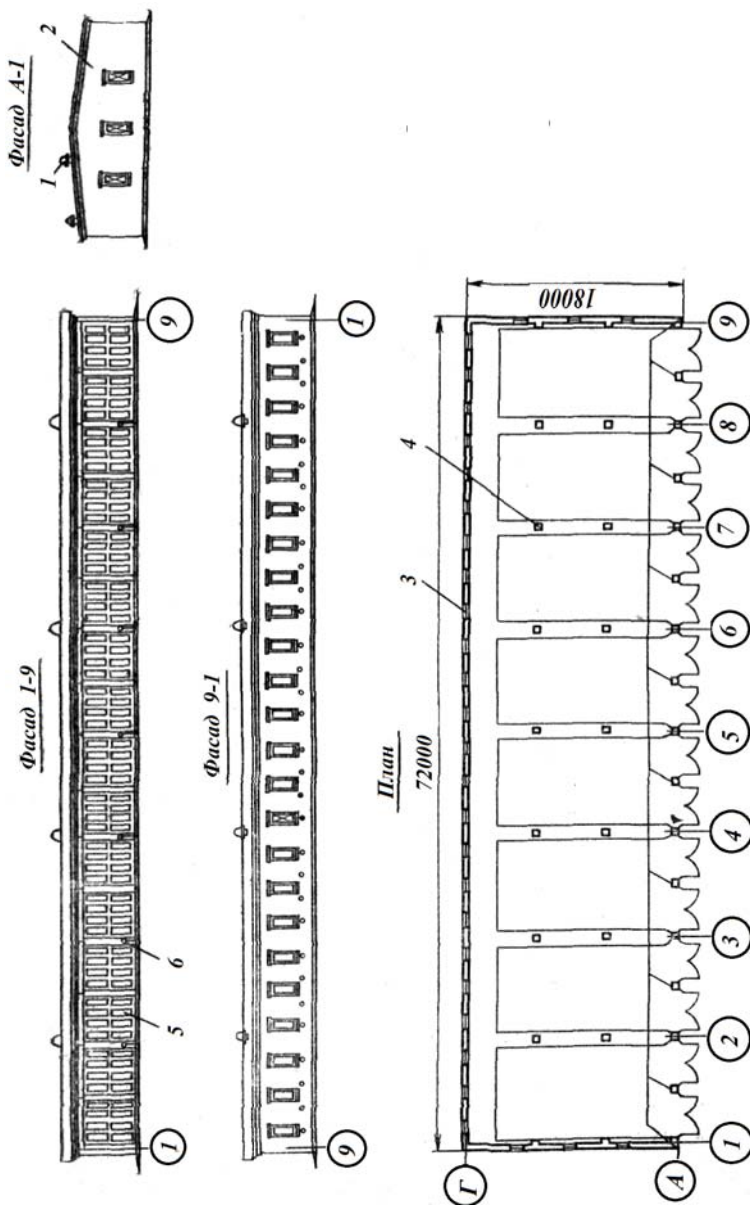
План и фасады неотапливаемого хранилища на 32 машины:
